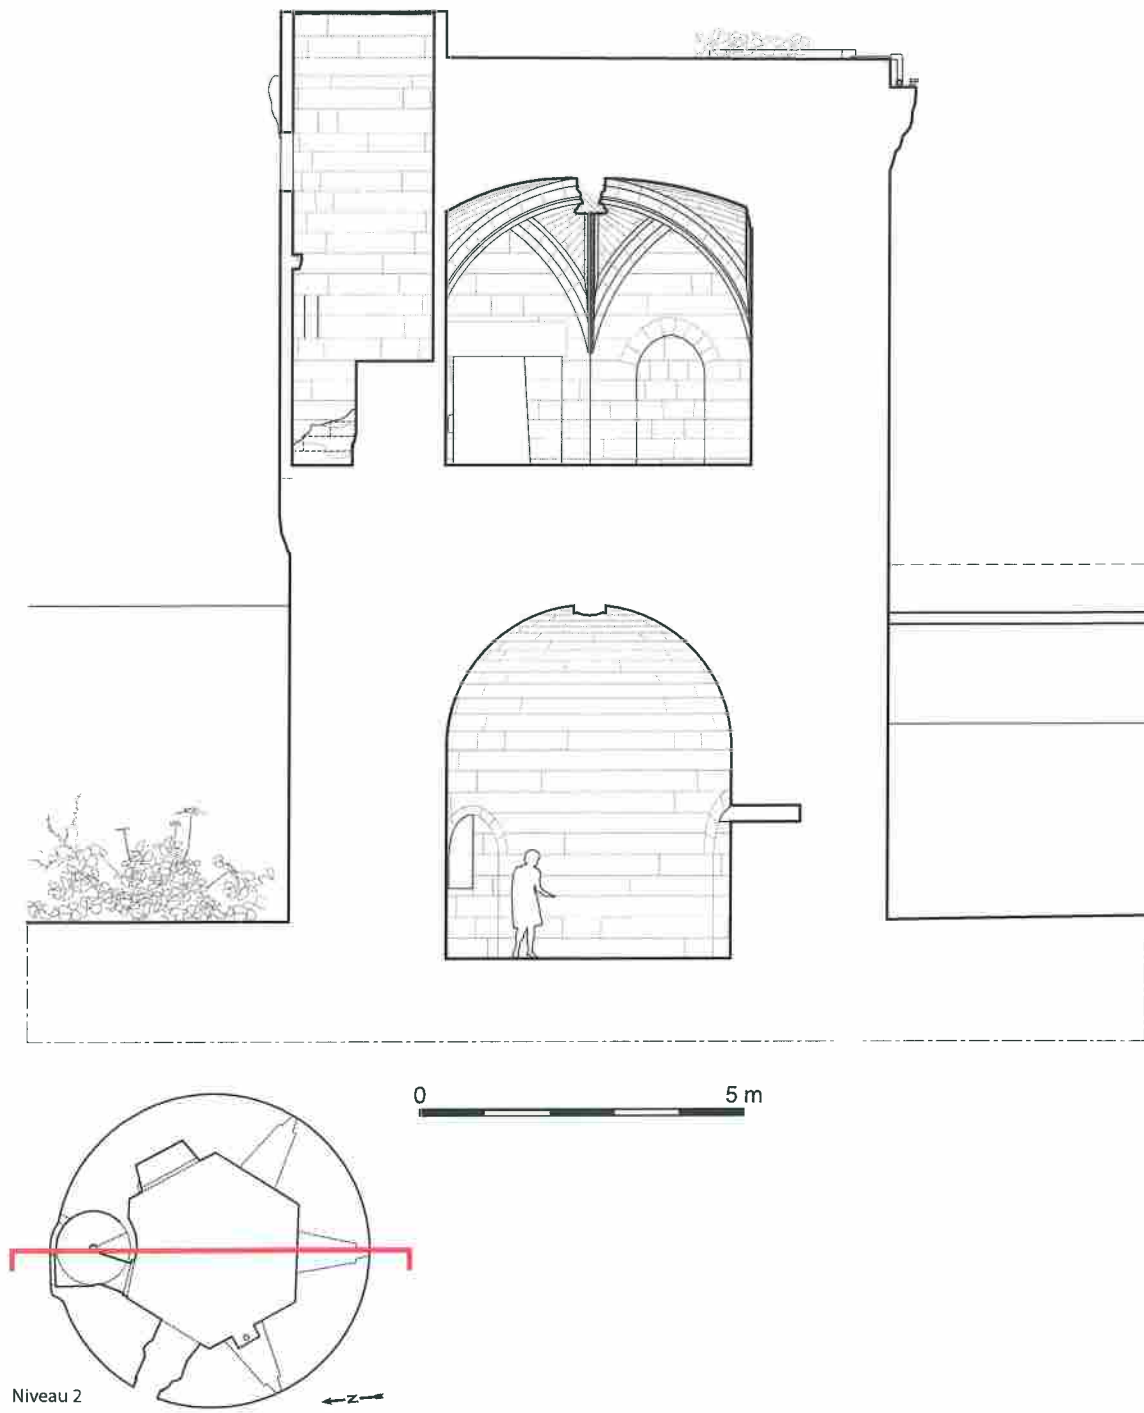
Coupe transversale vers l'est de la tour du Bourg (© M. S. de Ponthaud ACMH 2017).
